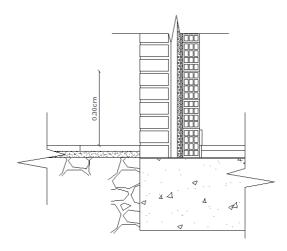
Arranque de fachada de doble hoja, caravista. Fuente: Edición propia
